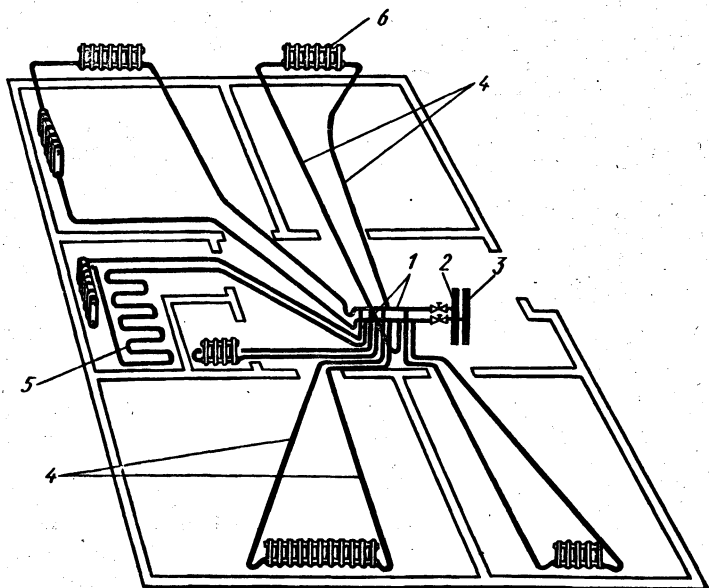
Лучевая схема разводки теплопроводов от вертикальных стояков у внутренних стен:
